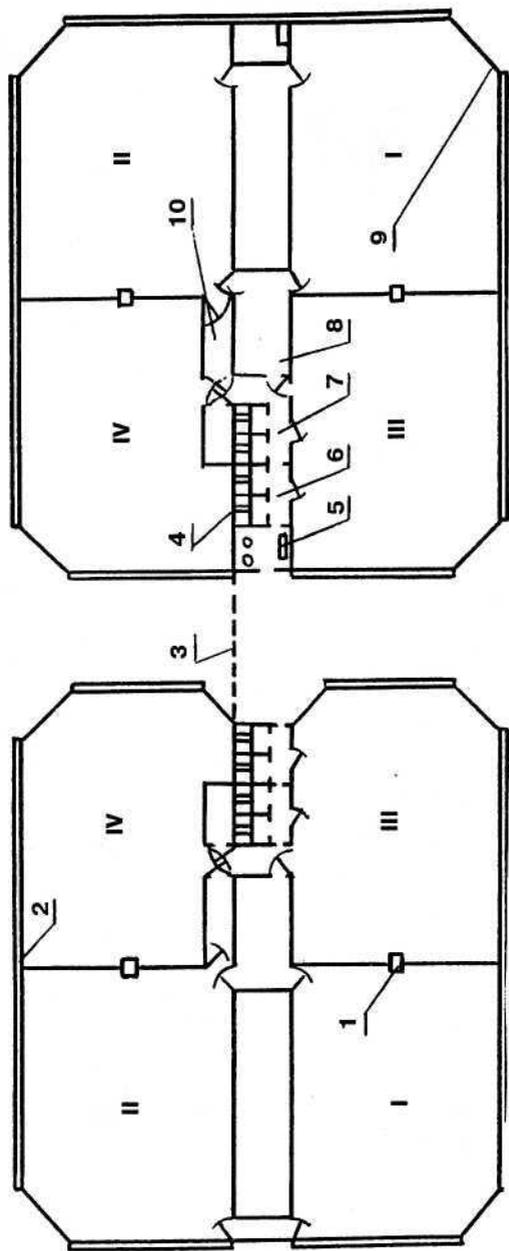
Схема выгульных площадок в летнем лагере для коров: 1 — автопоилки; 2 — кормушки; 3 — тру- допровод; 4 — доильная установка; 5 — молочный блок; 6 — преддоильный накопитель; 7 — наружные ворота; 8 — последоильный накопитель; 9 — помещение для грубого корма; 10 — вакуум-насосная
